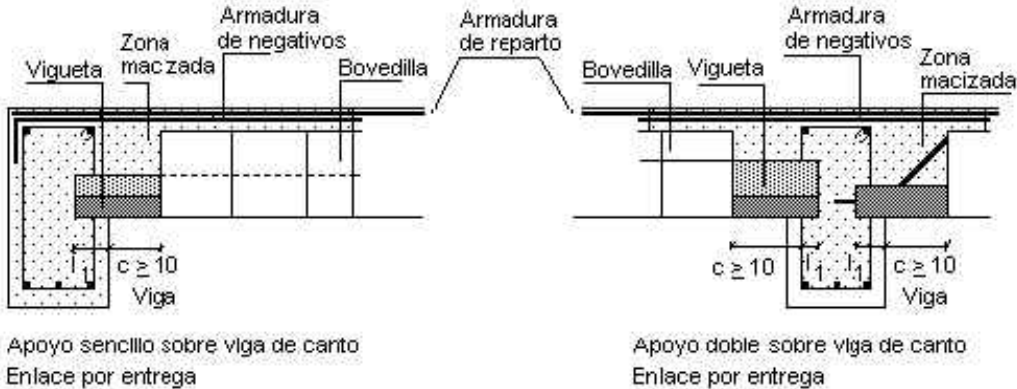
Detalle ilustrativo de la unión entre las vigas-viguetas.
